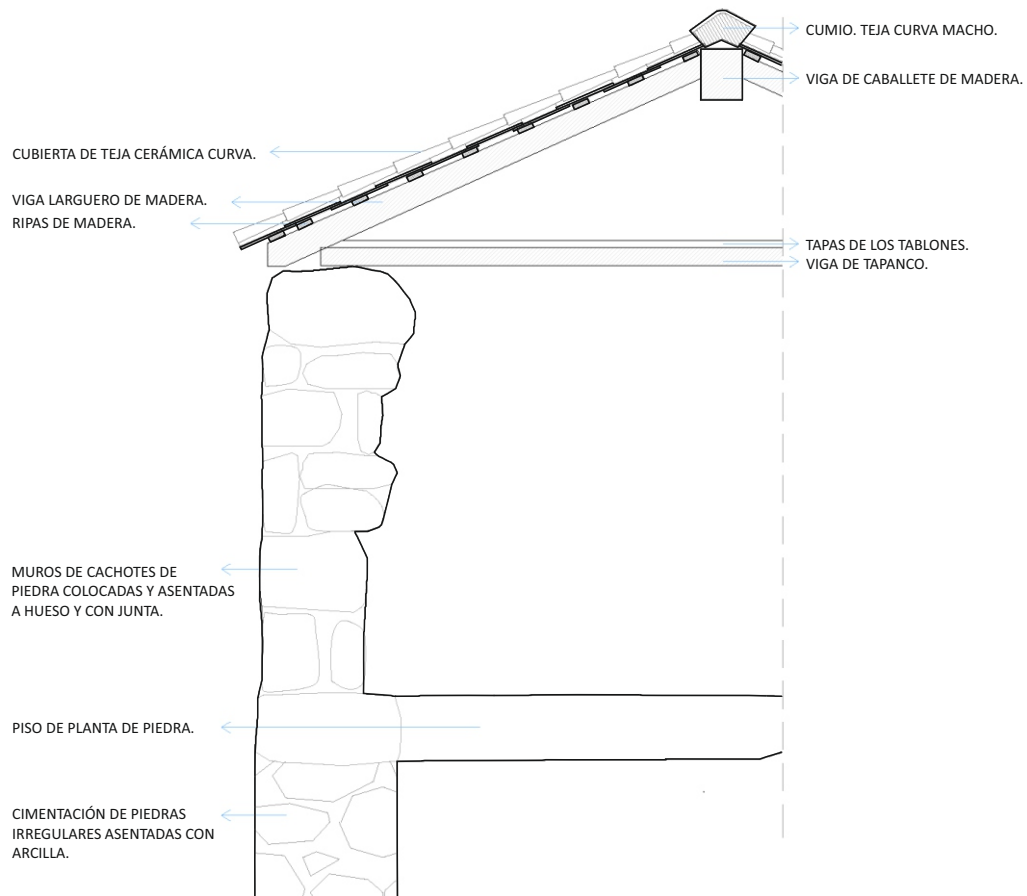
Ejemplo de un corte esquemático transversal del molino, desde la cubierta hasta la cimentación.
